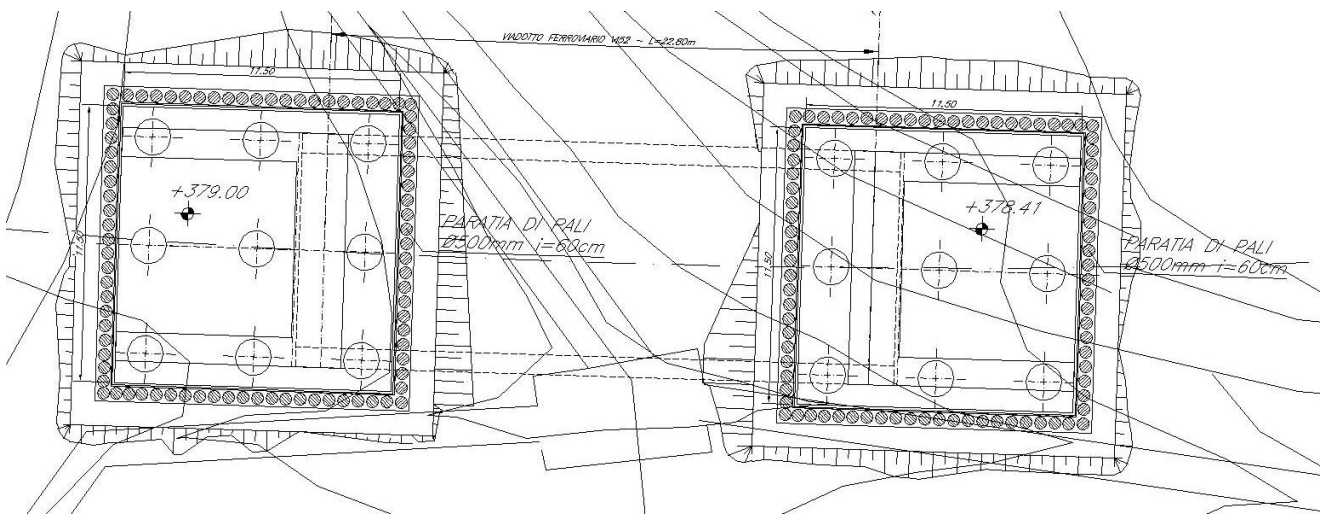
planimetria di scavo tipo con indicazione delle opere di sostegno
